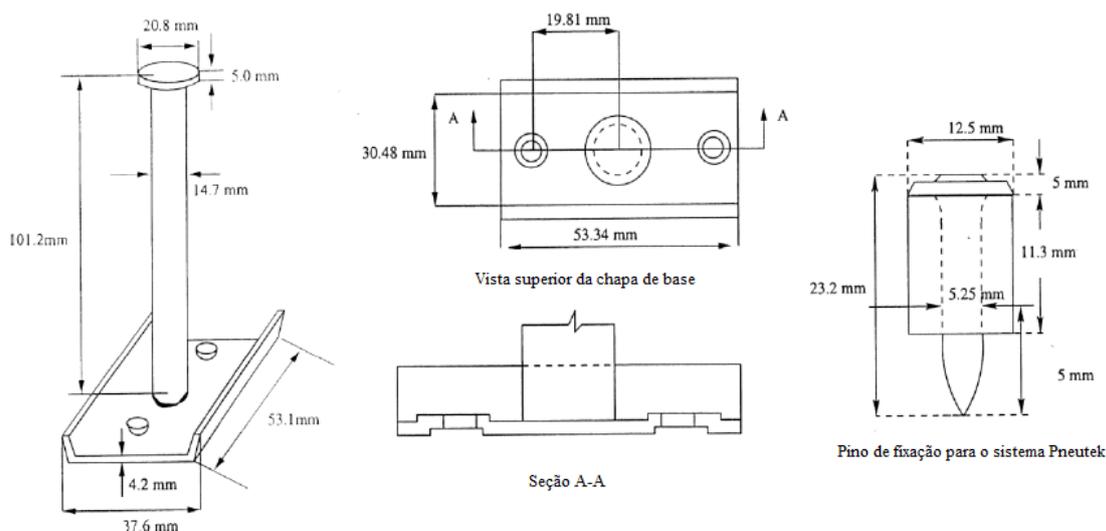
Conector não soldado (Tahir *et al*, 2009)
